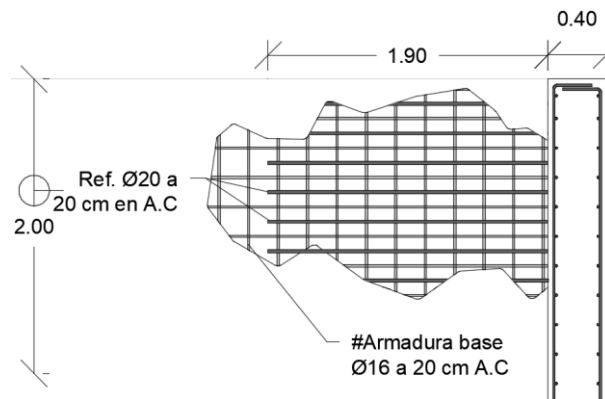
Refuerzo sobre armadura base en Muro Interno 1
